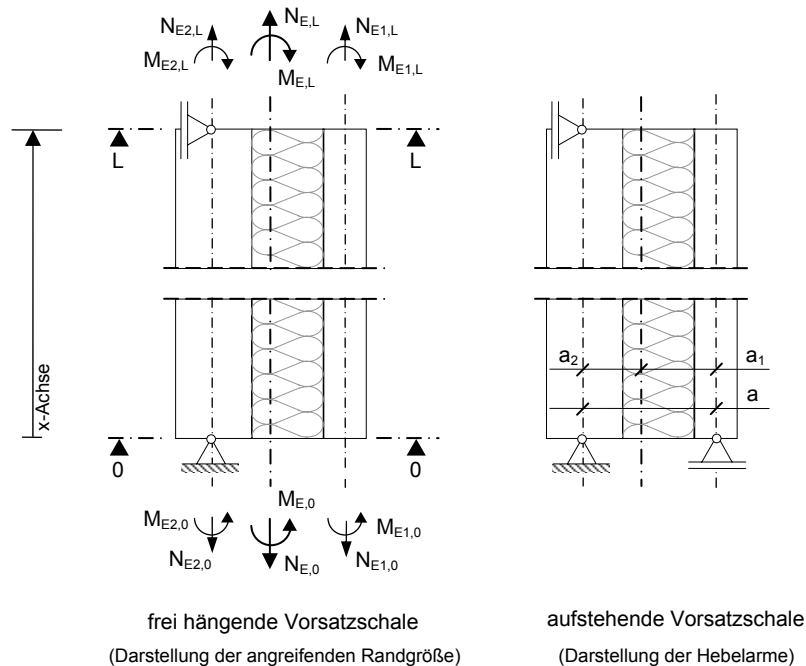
Lagerungsbedingungen und angreifende Randschnittgrößen bei mehrschichtigen Stahlbetonwandtafeln
